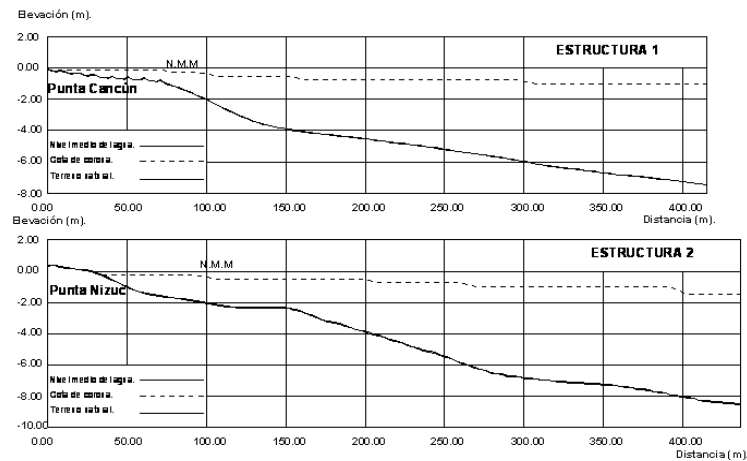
Fondo y cota de coronación estructuras 1 y 2.
